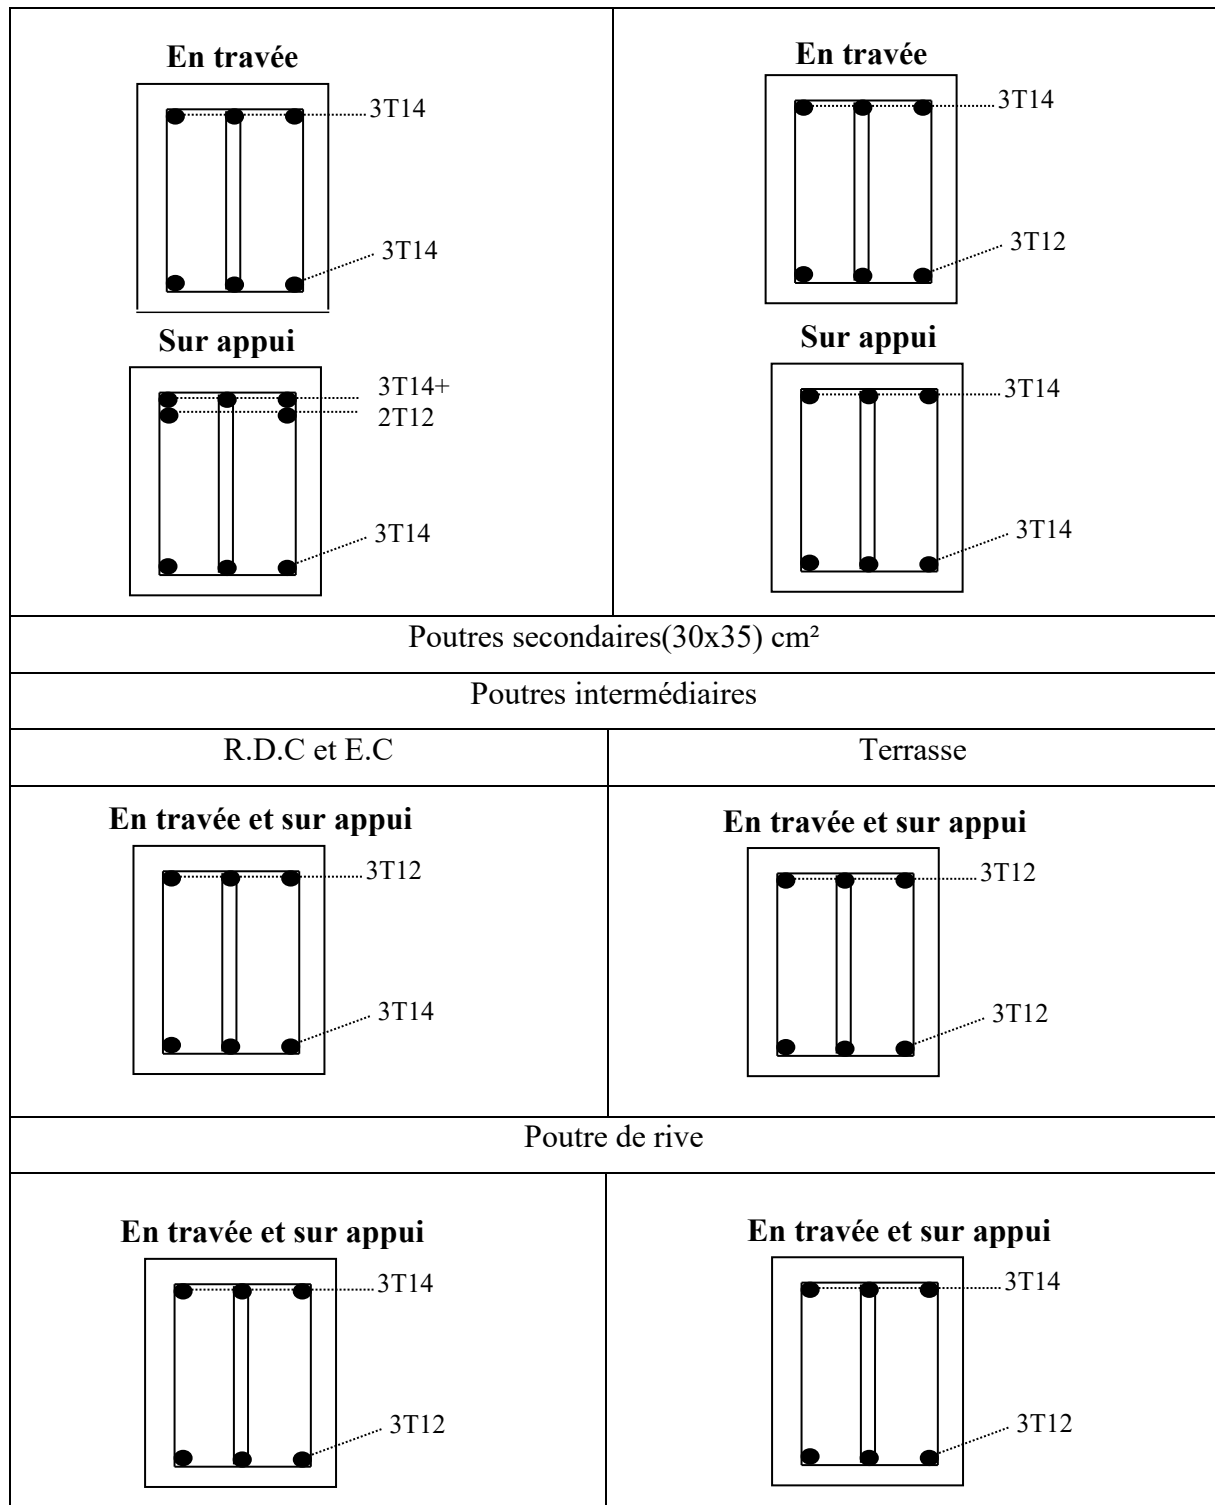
Dessin de ferrailage des sections des poutres principales et secondaires
